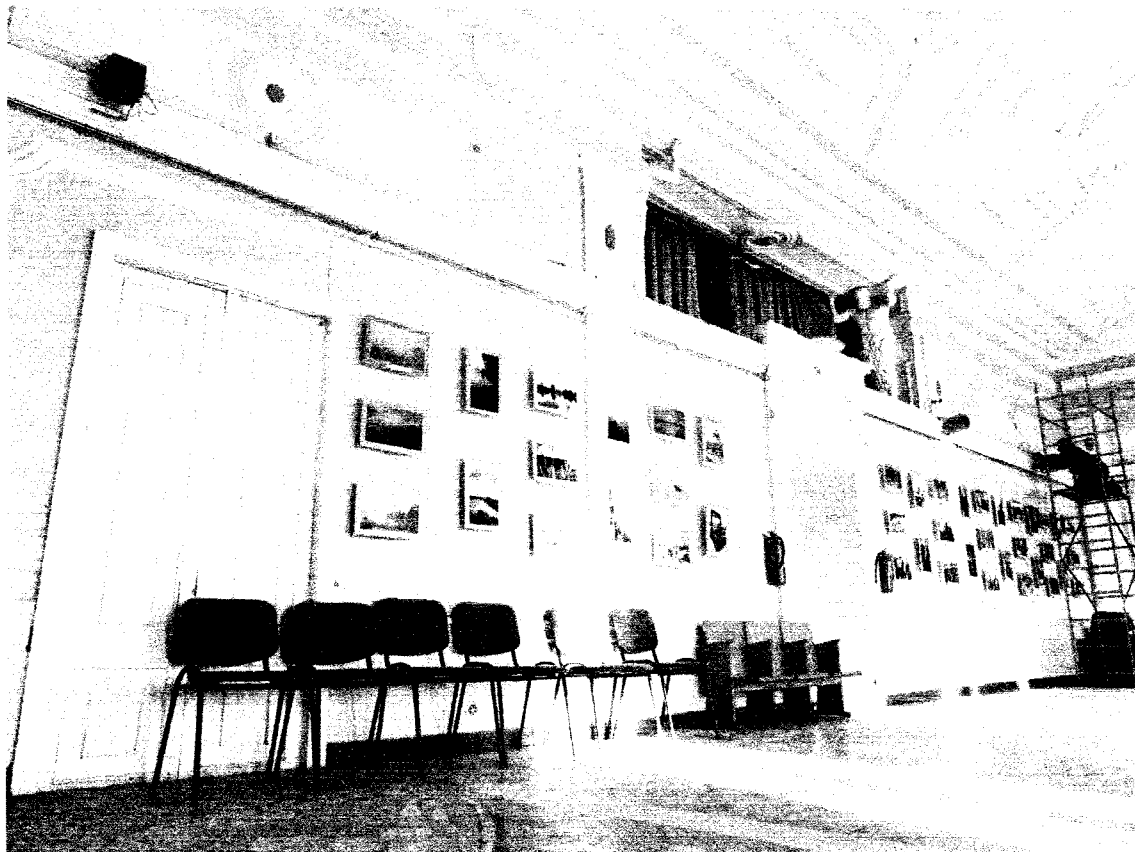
Второй этаж. Помещение 1. Стена с ложей над дверным проемом
